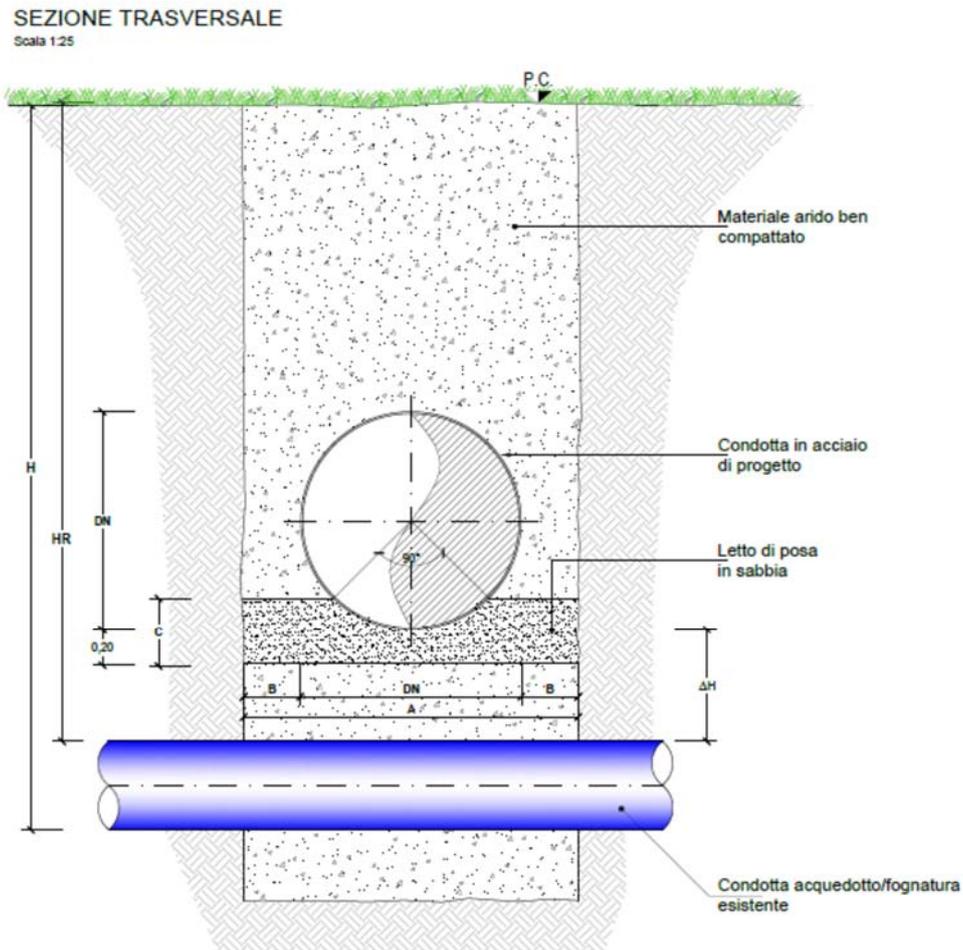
Sezione tipologica trasversale di attraversamento (sovrappasso)
